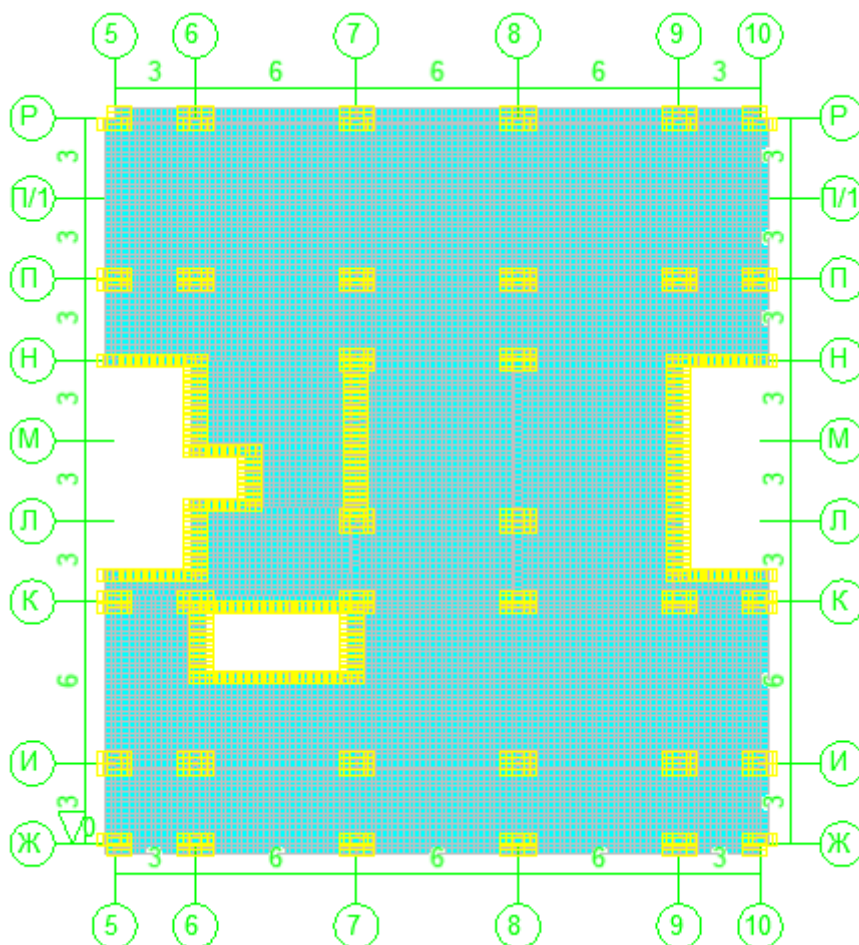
Расчетная схема плиты перекрытия в плоскости
